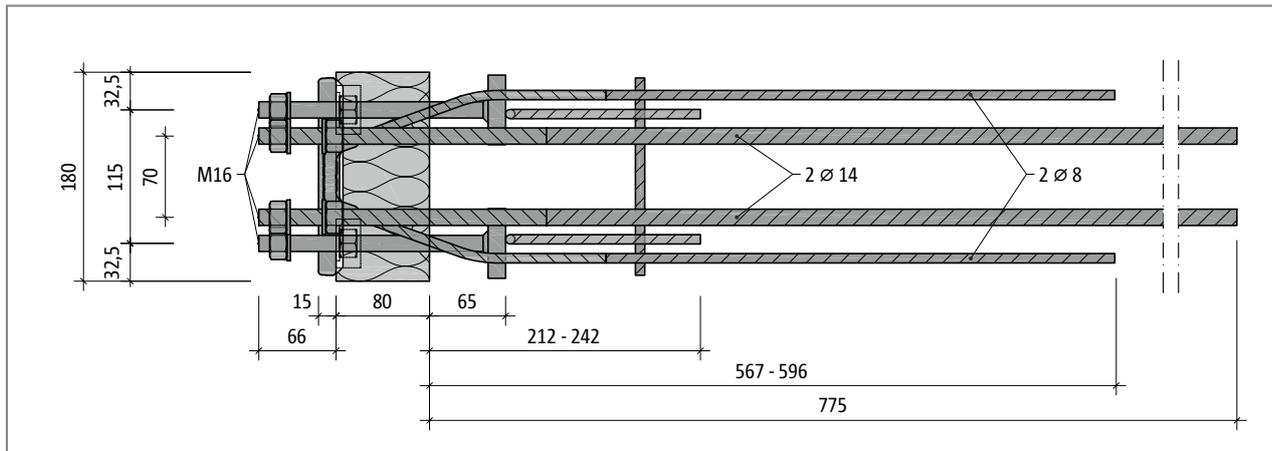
Schöck Isokorb® T Typ SK-M1-V1: Grundriss
